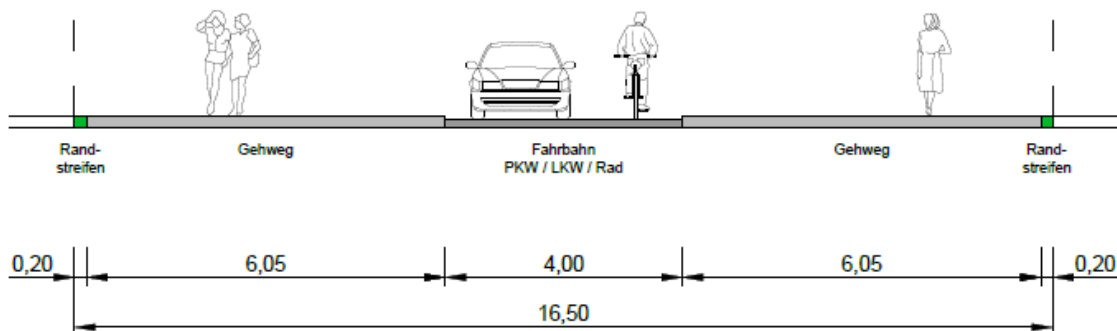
Straßenquerschnitt „Einengung Planstraße A“, ohne Maßstab
